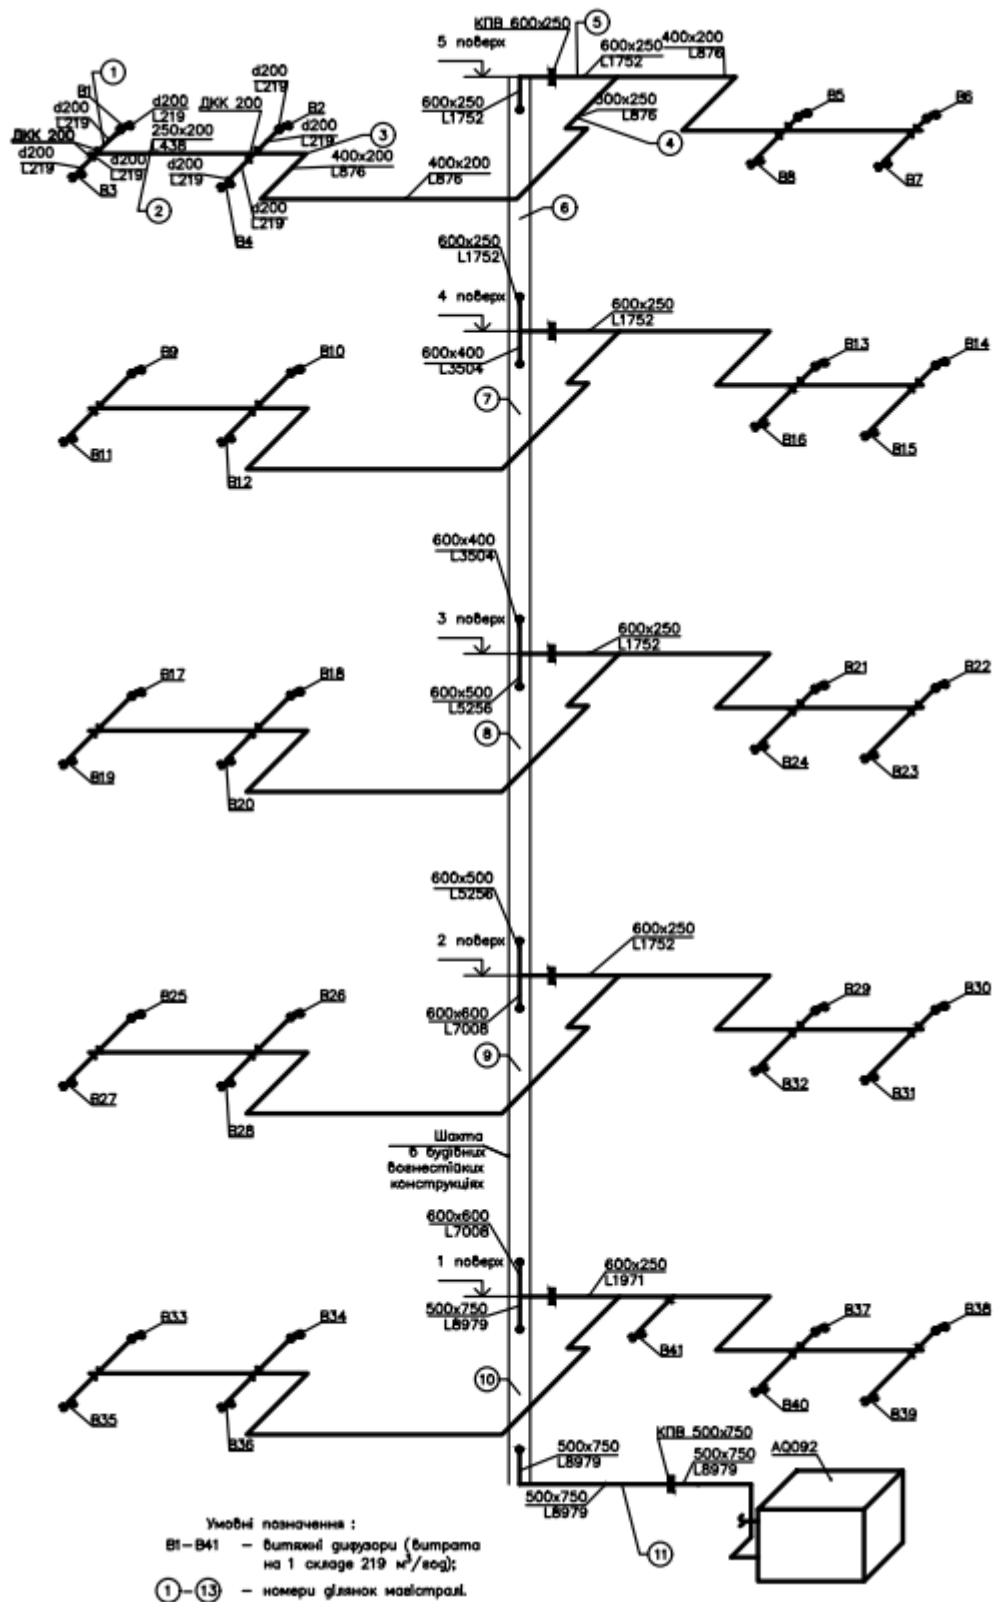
Розрахункова схема витяжних повітропроводів системи вентиляції
